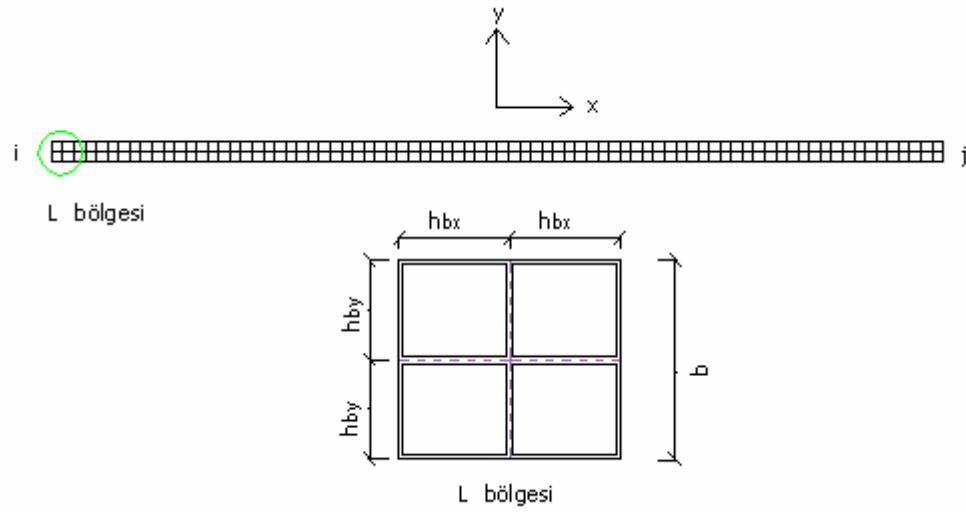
x-z düzlemindeki gövde çerçeve elemanların geometrisi
